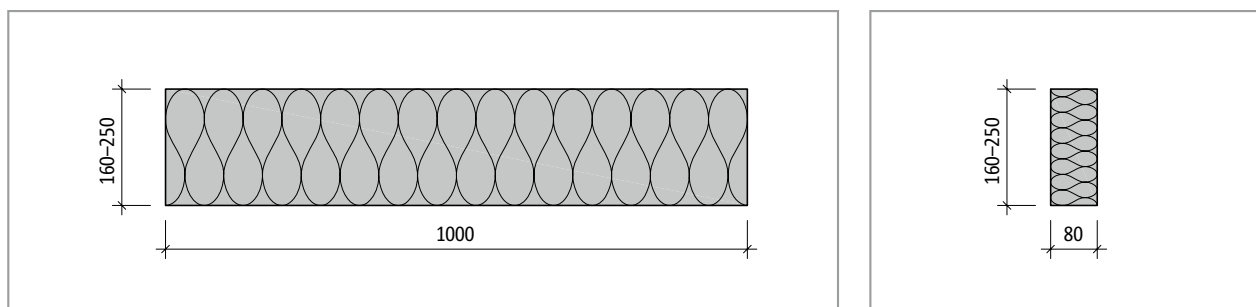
Schöck Isokorb® T tipo Z-EI0: Vista y sección del producto
